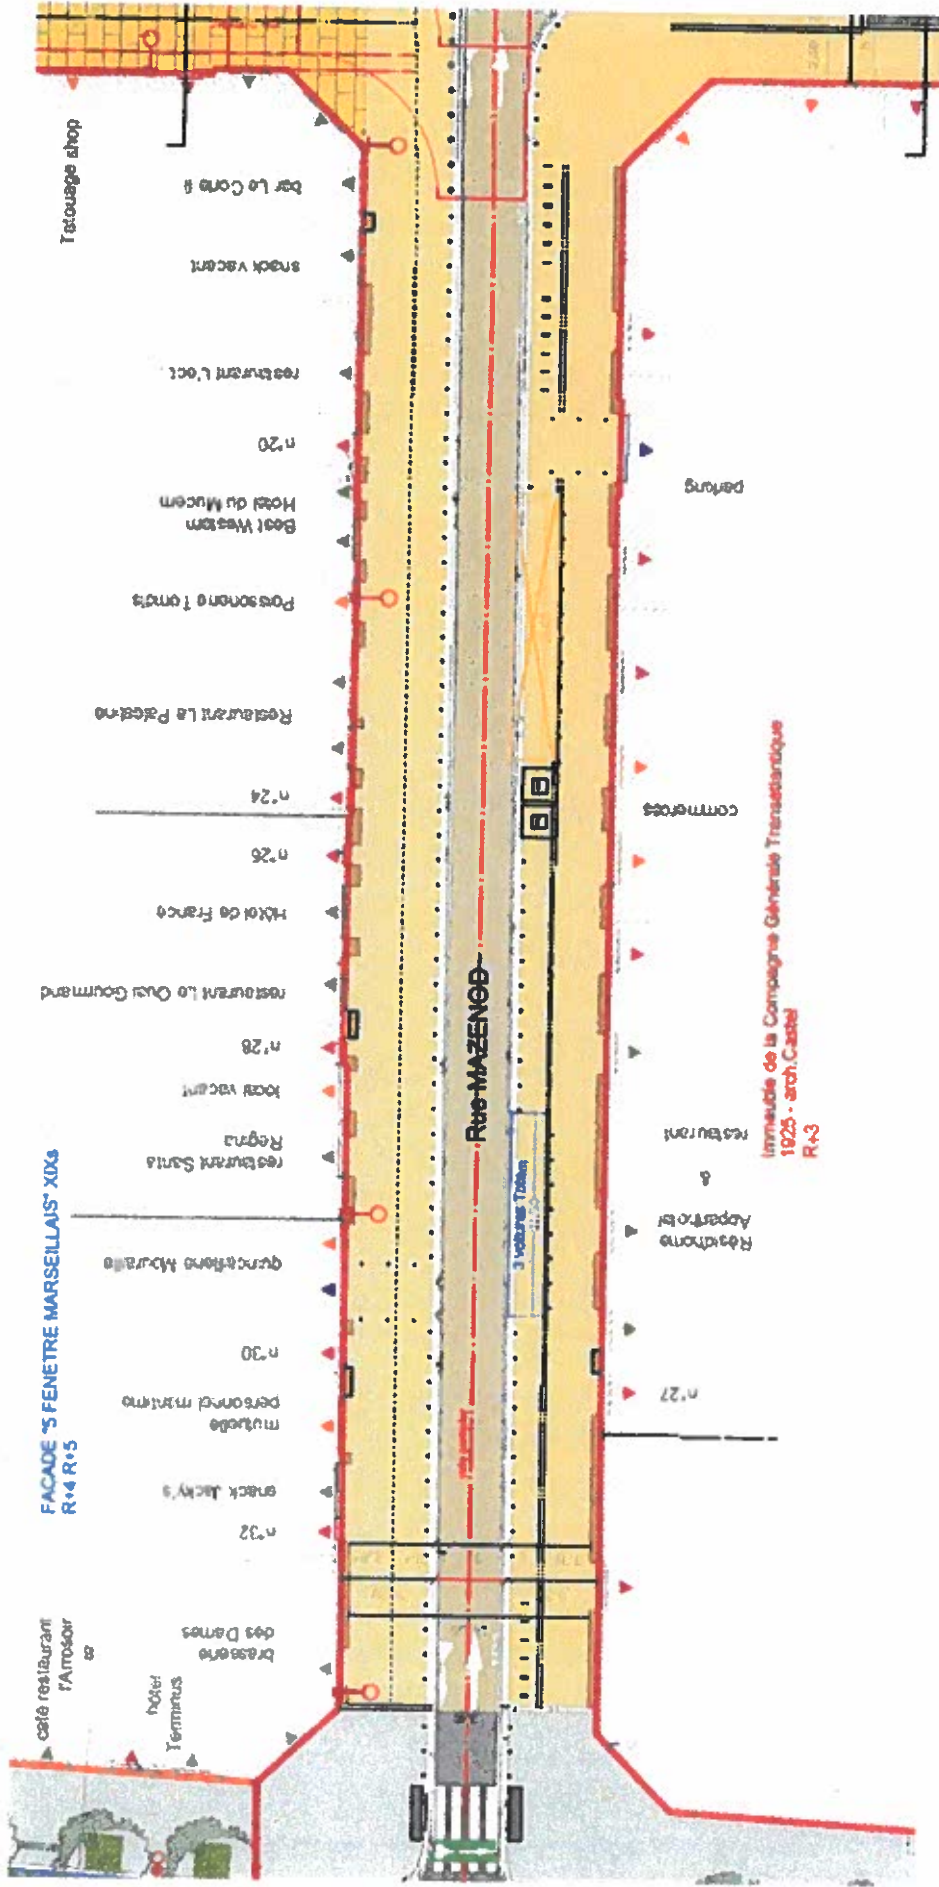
Plan Général des Travaux (3/5) – Section Rue Mazenod entre le boulevard des Dames et la rue Léca
